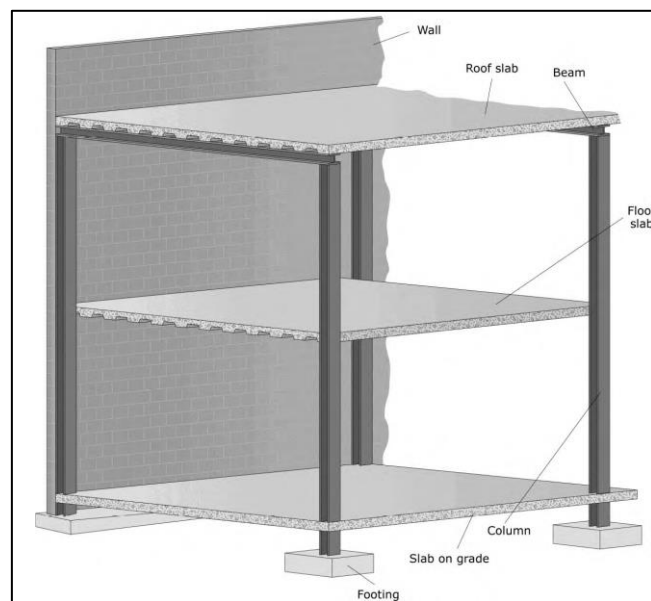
Vista 3D de una estructura genérica de un edificio.
